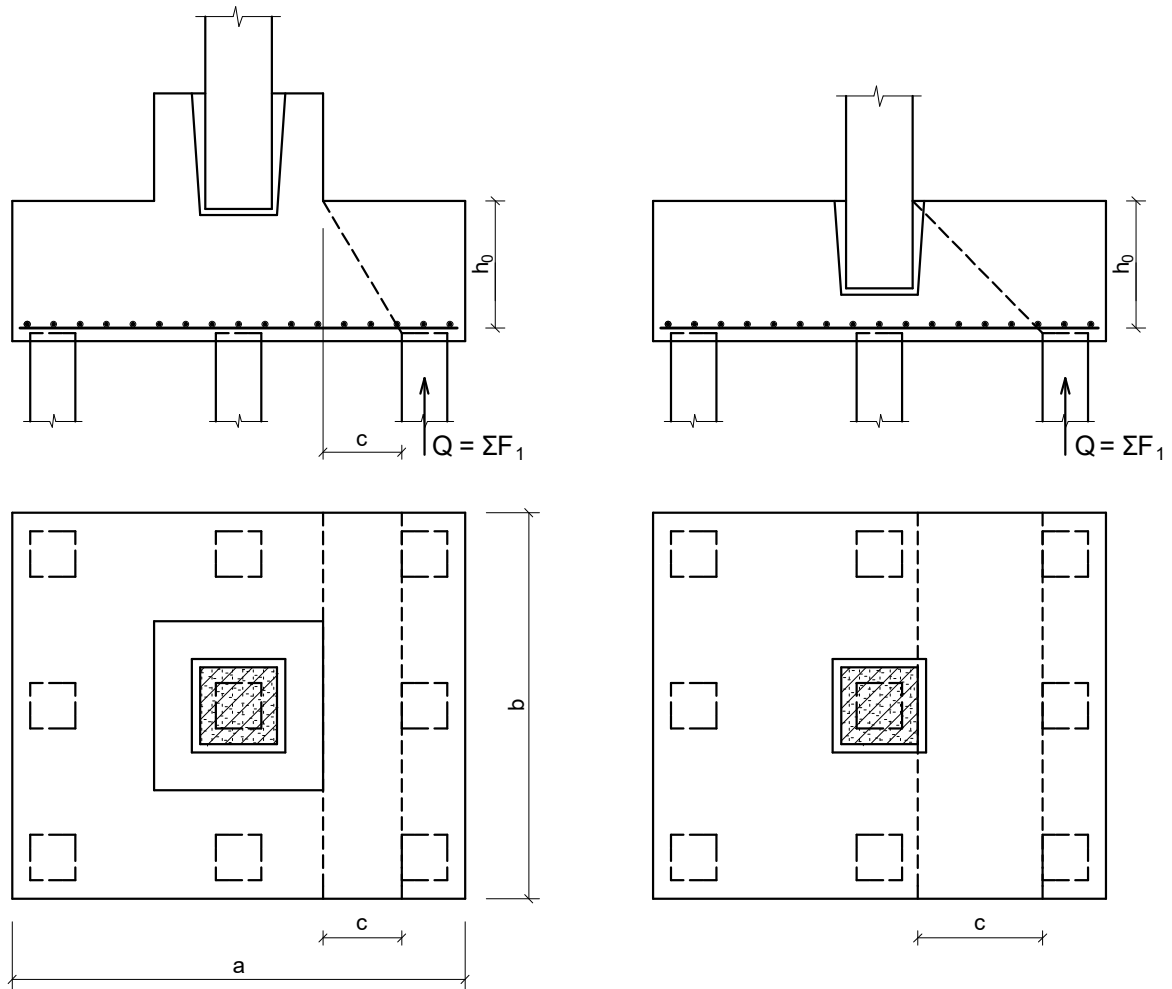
Схеми, що приймаються при розрахунку міцності нахилених перерізів по поперечній силі для ростверка з підколонником і для плитного ростверка
